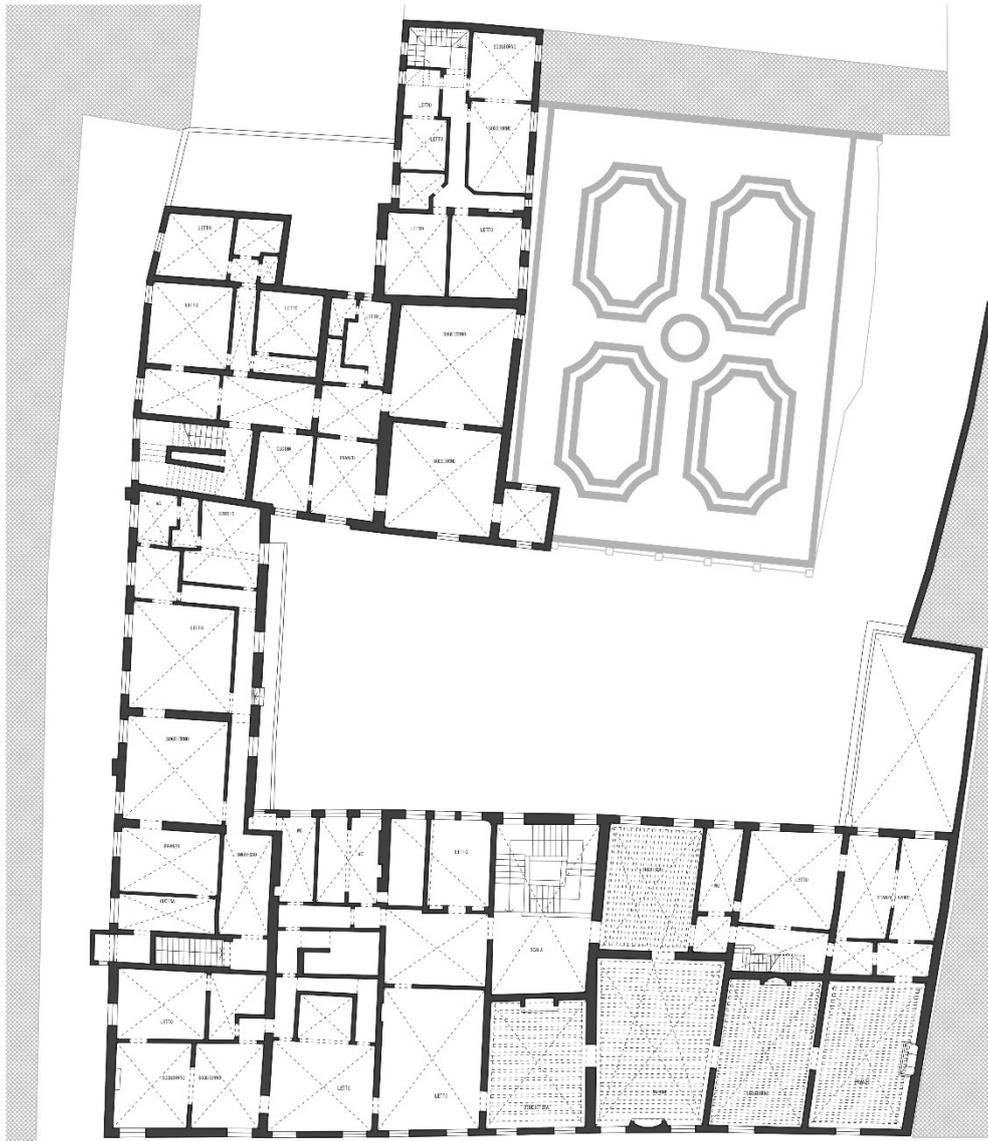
Palazzo Selvatico, Padova, via Vescovado. Pianta del primo piano.
